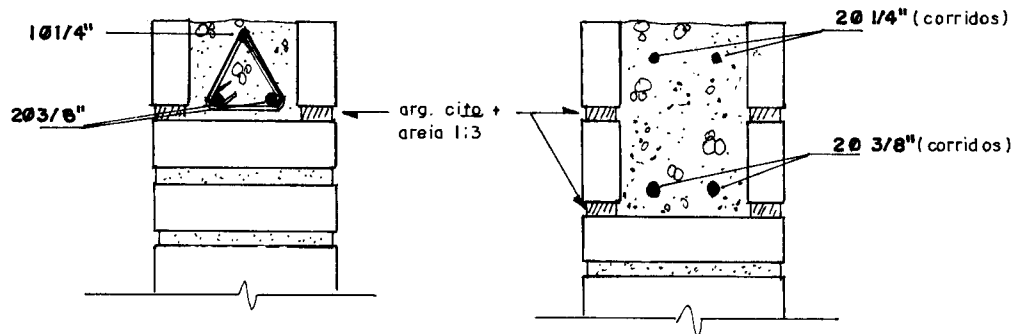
Cinta de amarração em alvenaria de bloco de concreto
